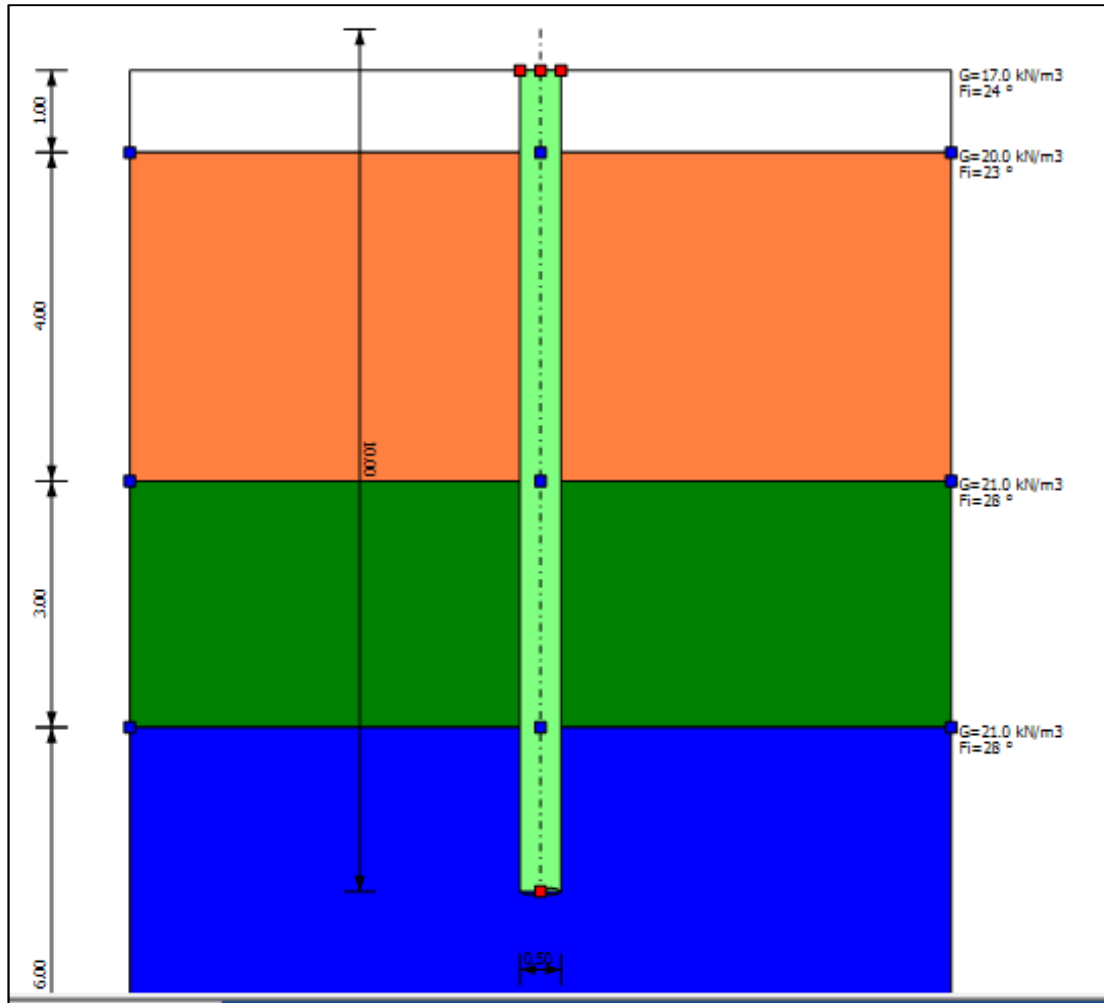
Modello stratigrafico con ipotesi di fondazione su pali.
